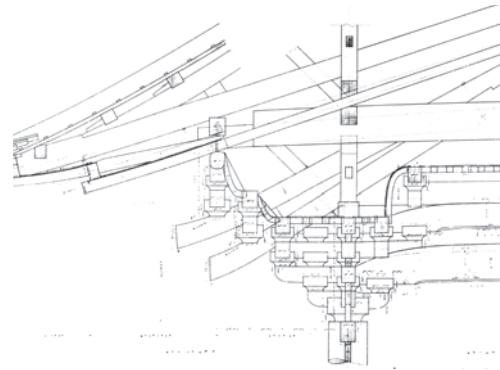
喜光寺本堂 身舎部分断面図
